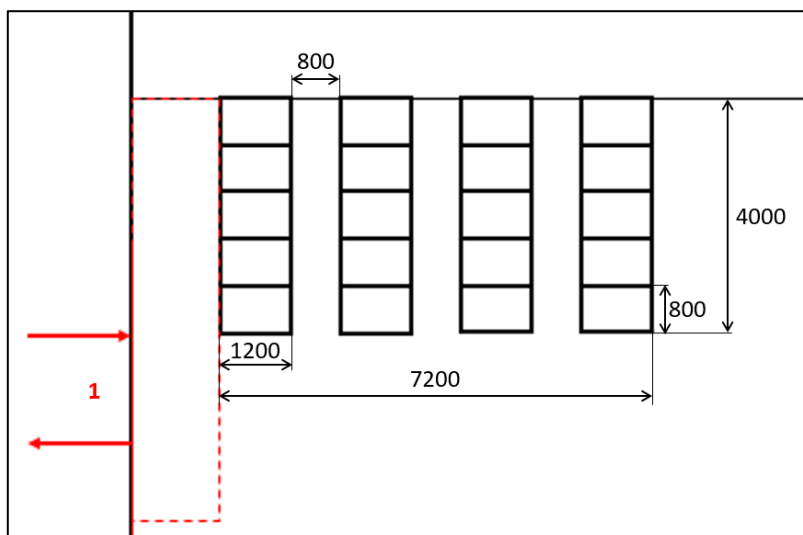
Planta da zona de receção de mercadoria. 1 – Entrada e saída do armazém
